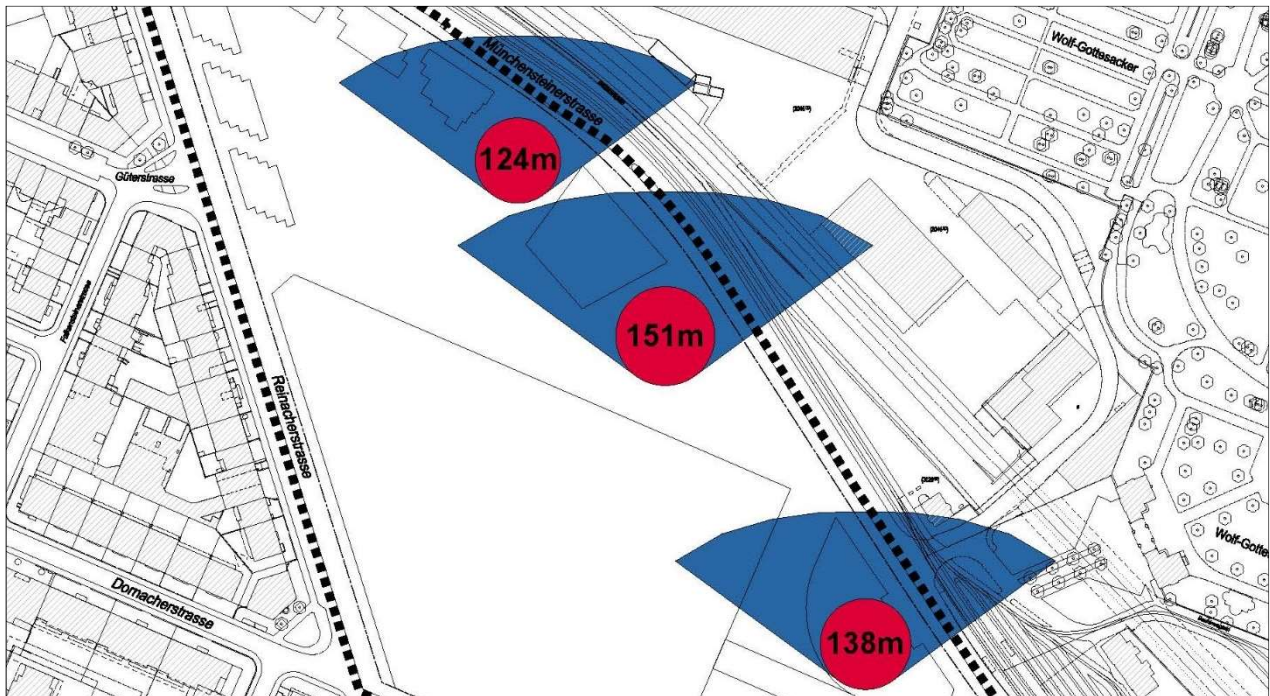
2 Stunden-Schatten der drei Hochhäuser auf dem Areal Dreispitz Nord. (Kein Massstab, Plan genordet)
